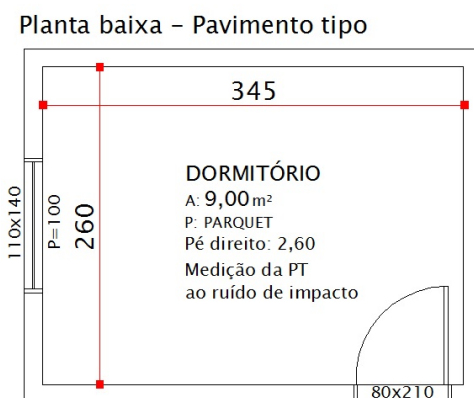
Planta baixa - pavimento tipo - 02-PIS-PC
